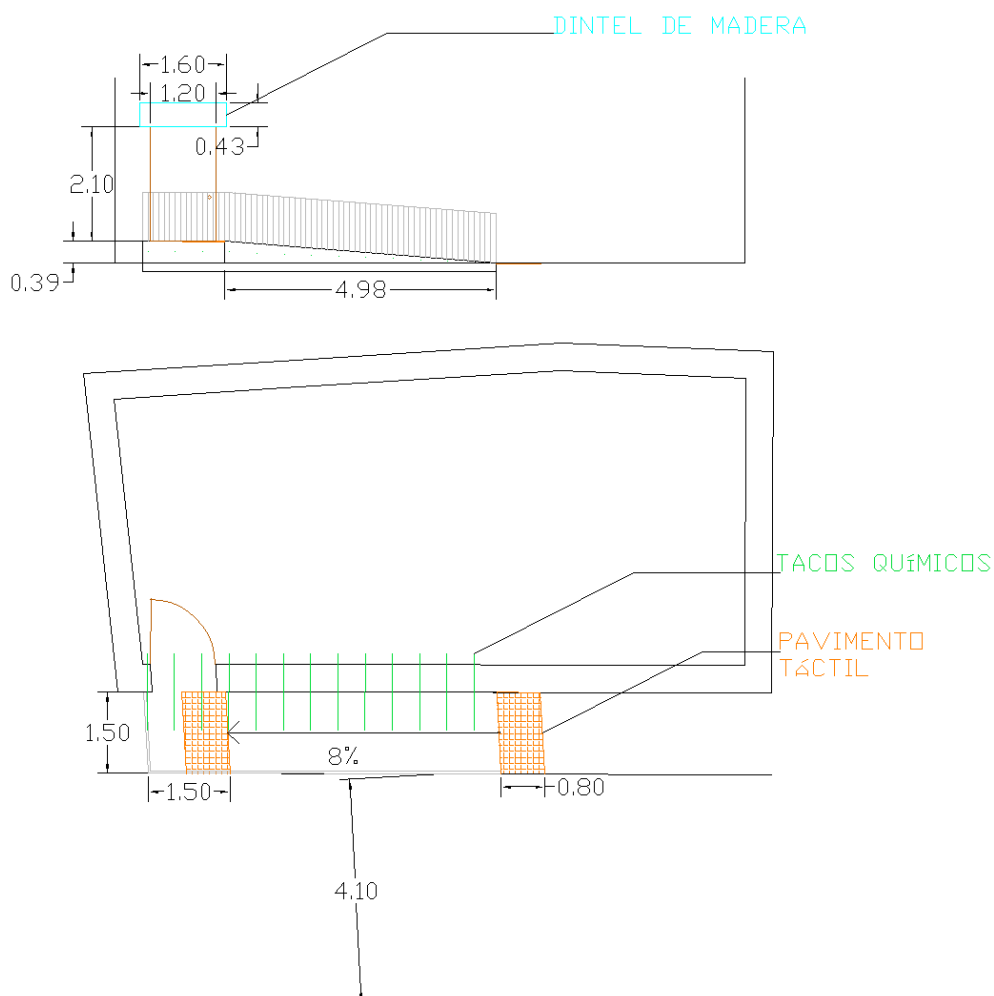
Estado reformado acceso consultorio. Fuente: Propia
